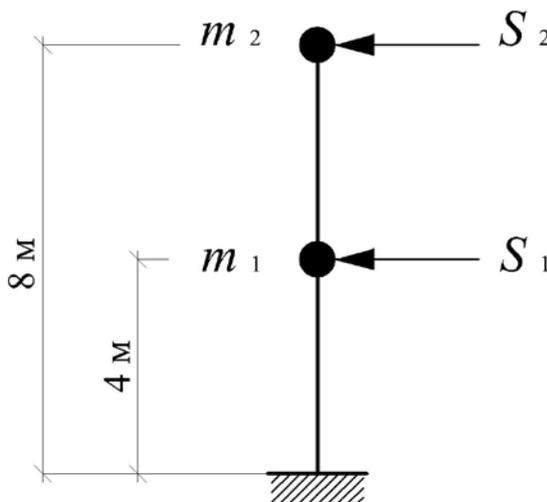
К примеру определения расчетной сейсмической нагрузки на здание
